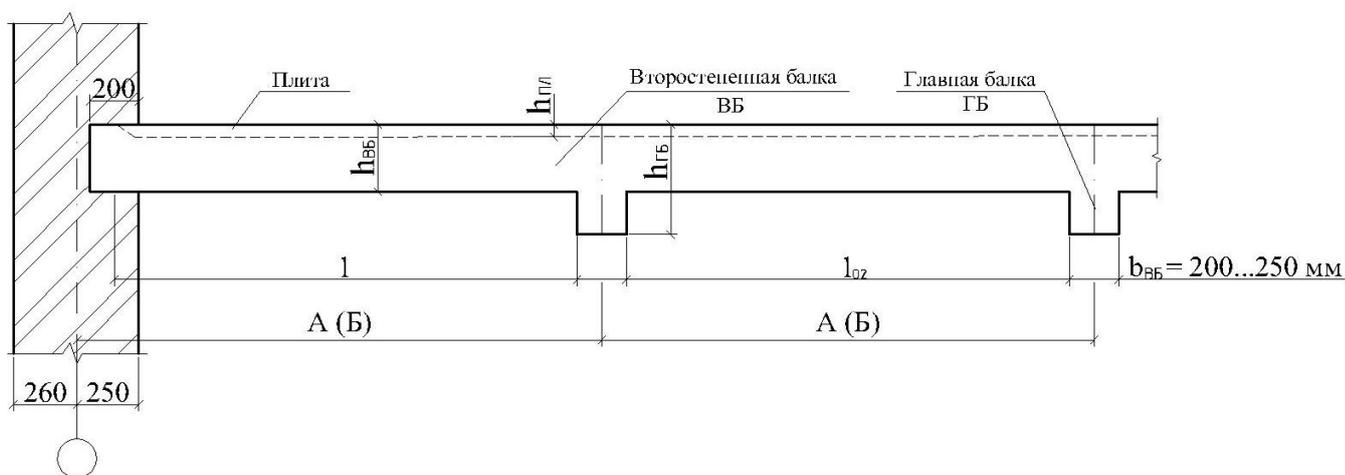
Схема назначения расчетных пролетов второстепенных балок
